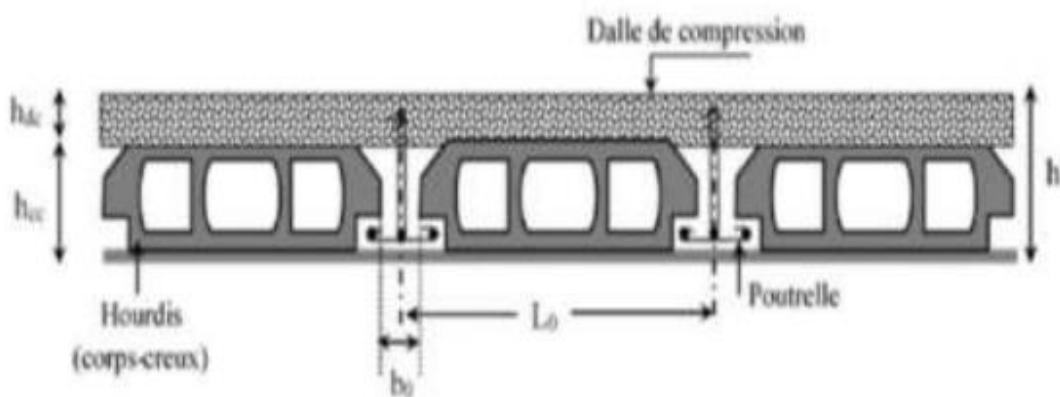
Coupe transversale d'un plancher à corps creux
